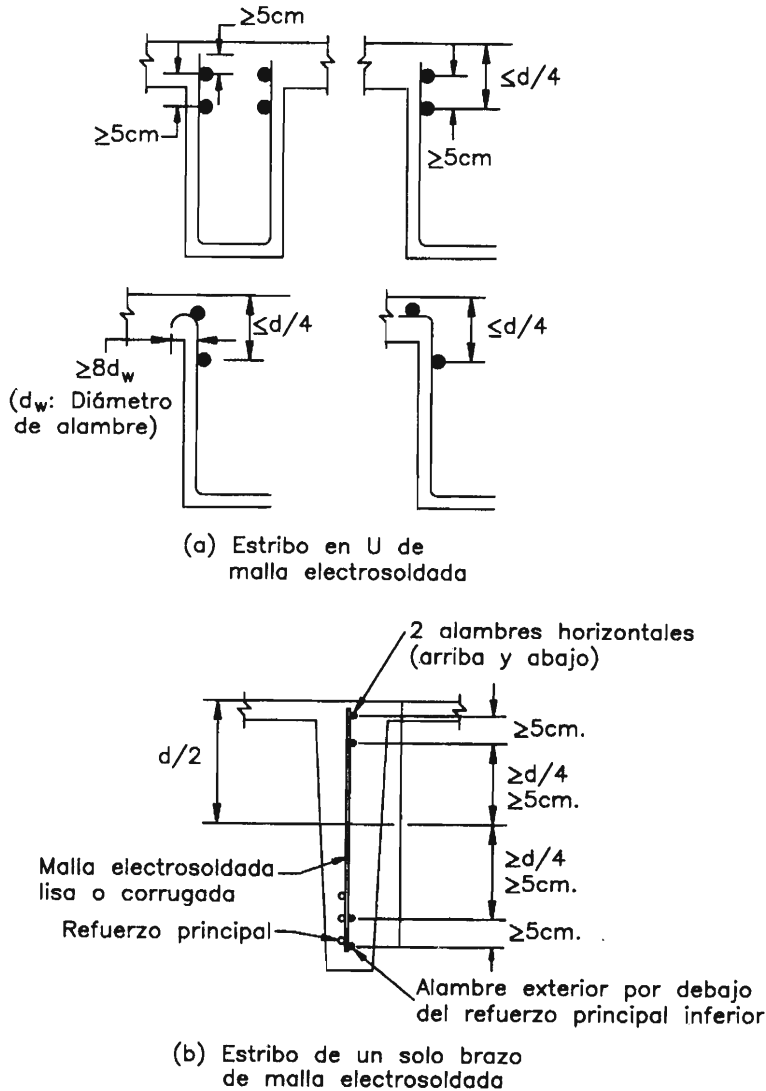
Algunos tipos de estribos fabricados en base a mallas electrosoldadas
